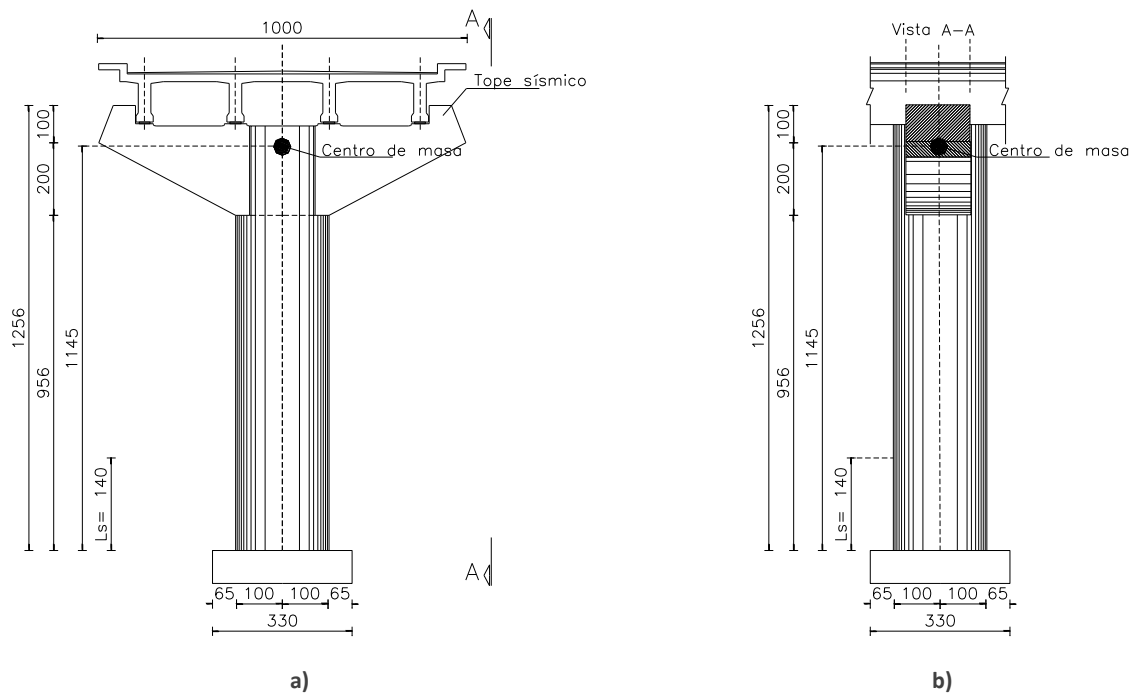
Dimensiones de la pila: a) vista longitudinal y; b) vista transversal.
